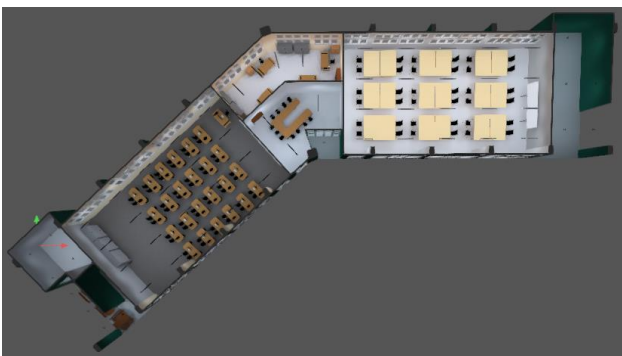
Gedung B lantai 2 Teknik Arsitektur
